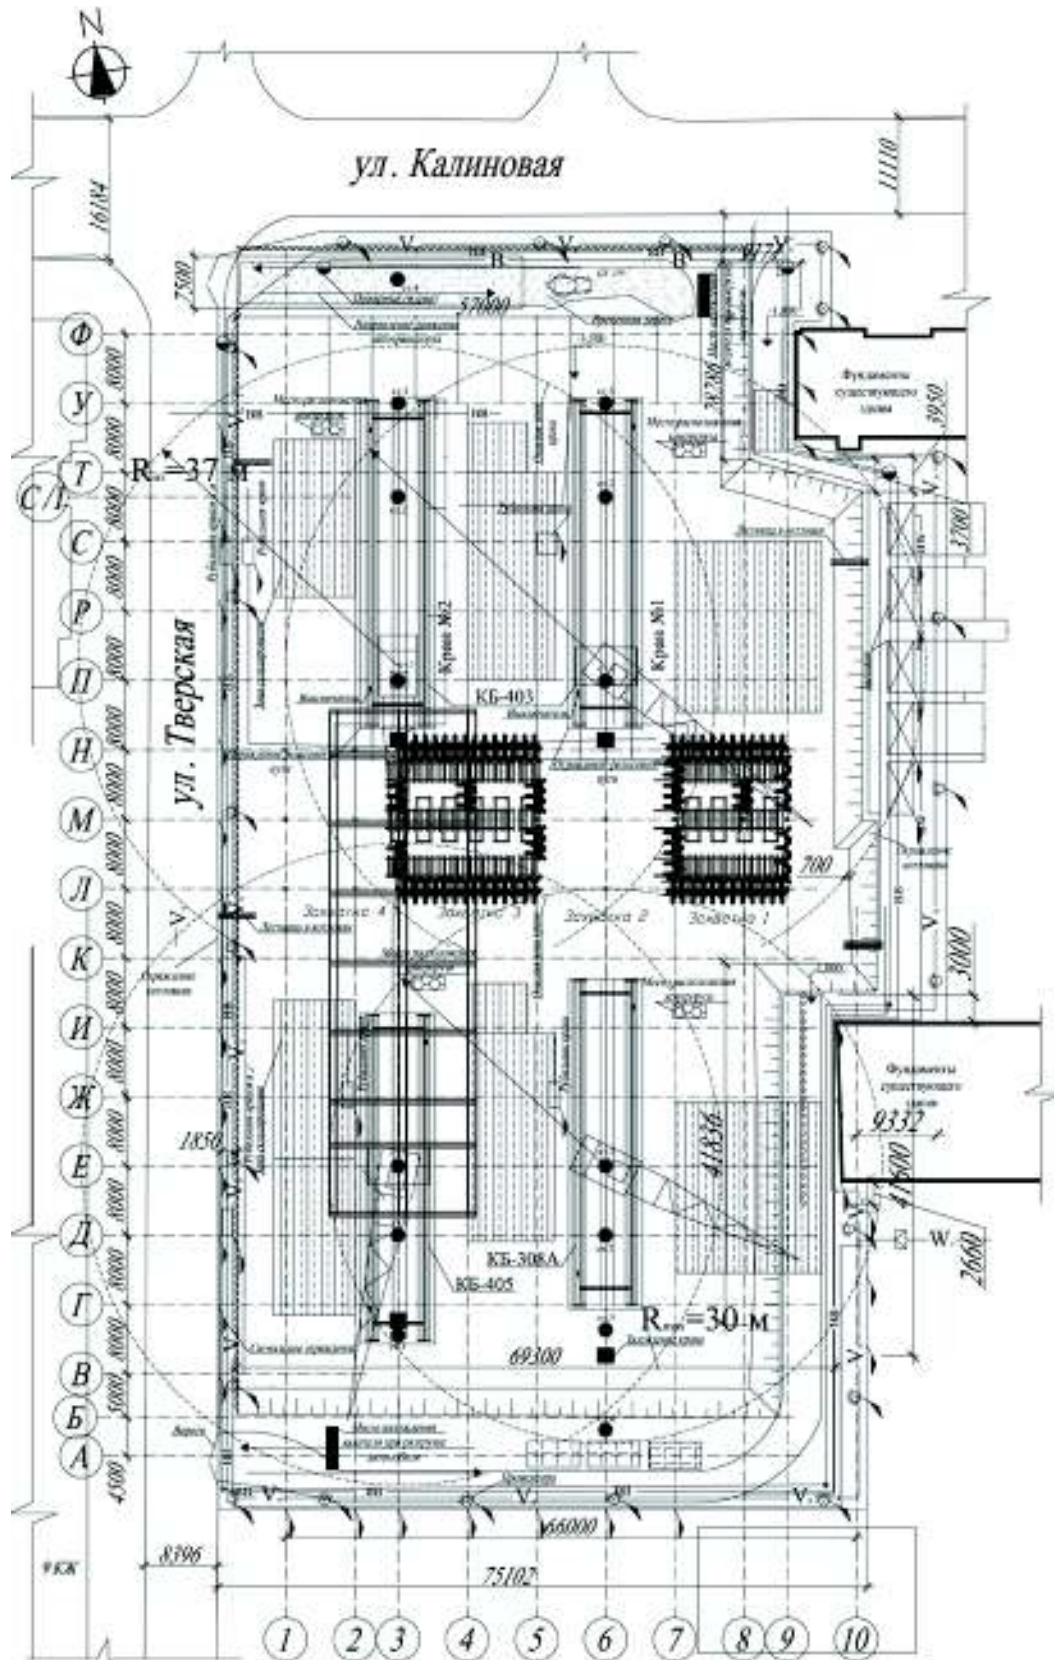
Схема строительного генерального плана на начальном I этапе устройства конструкций сборно-монолитного каркаса
